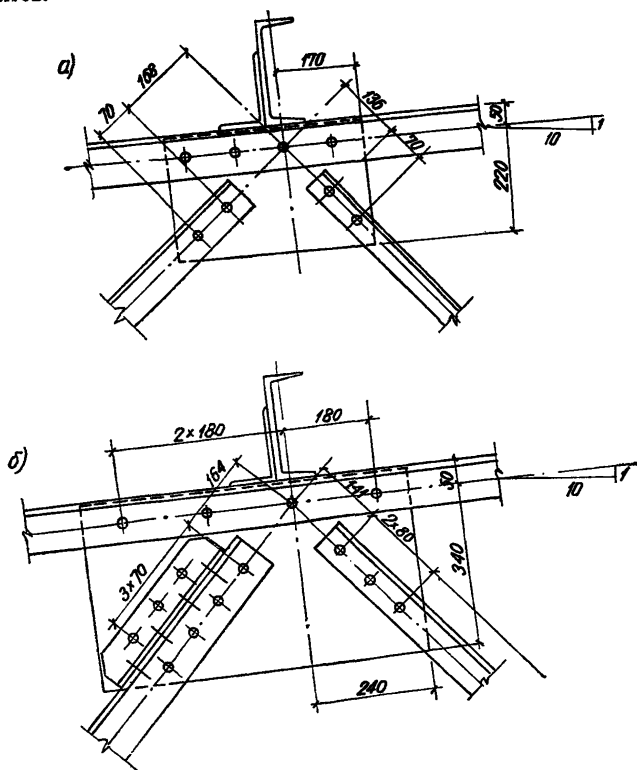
Промежуточные узлы верхнего пояса клепанной стропильной фермы
